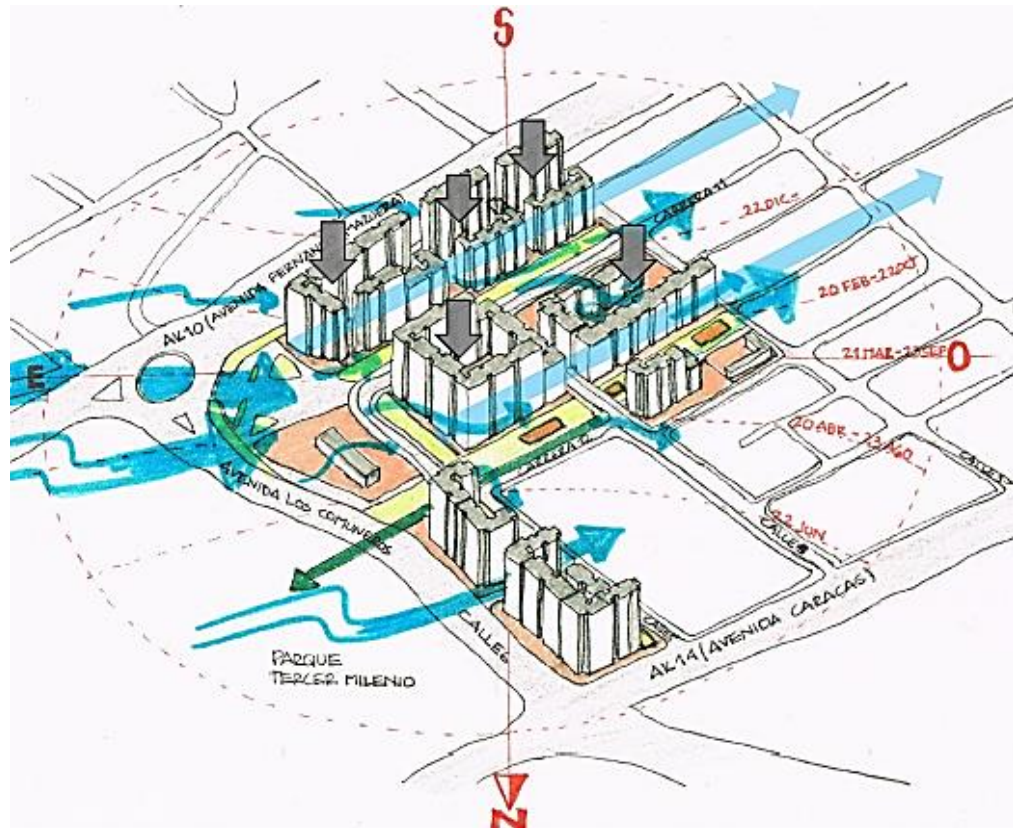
Planteamiento Inicial Plan de Renovación Urbana San Bernardo Tercer Milenio
